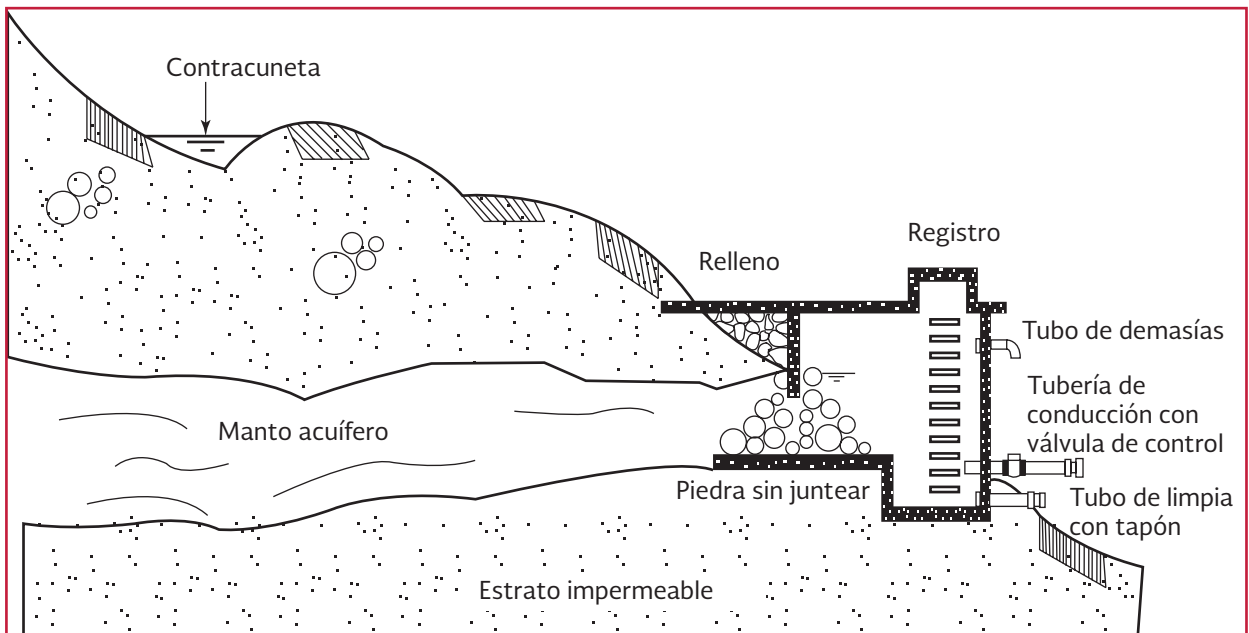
Venero protegido por una cámara formada por muro y estructura de cubierta
